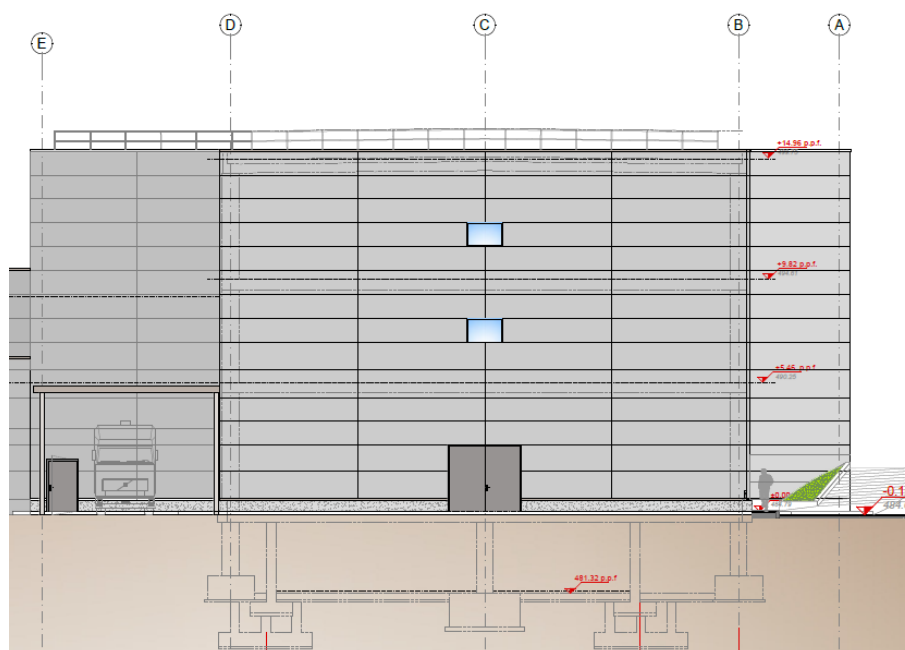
Prospetto Nord - Fabbricato Ex. Piemonte
